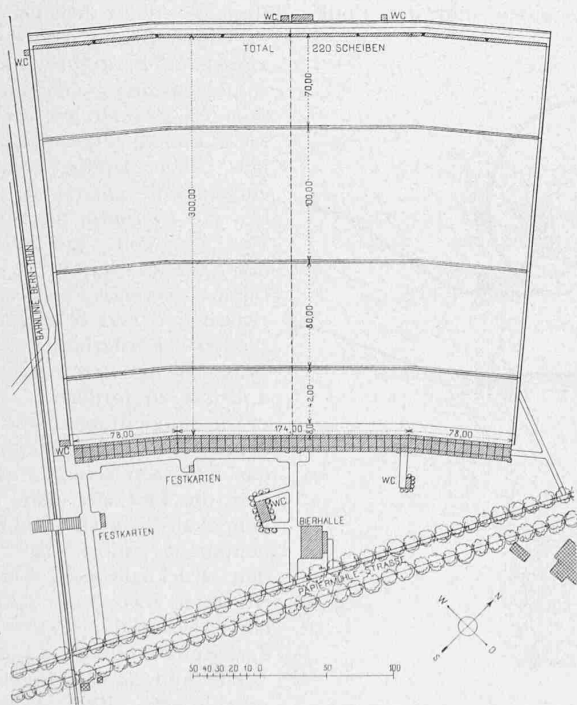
Lageplan der Schiessanlagen. — Masstab 1 : 5000.
